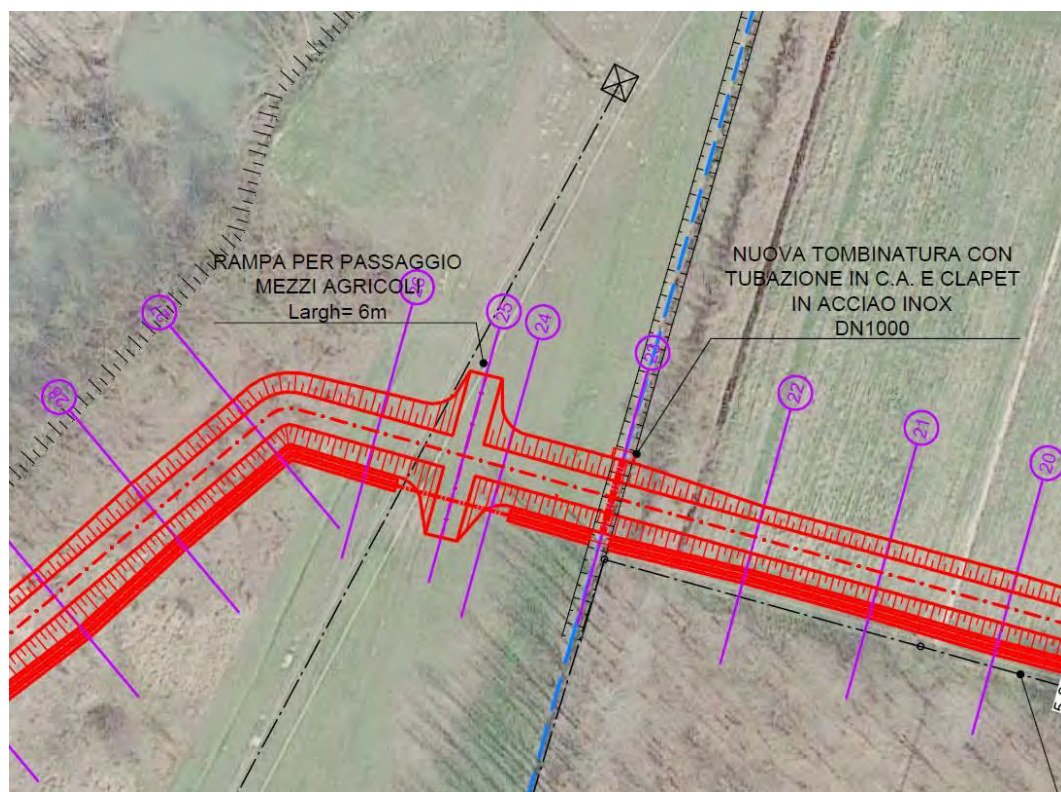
posizione linea elettrica Terna e traliccio di sostegno (stralcio planimetria di progetto).
